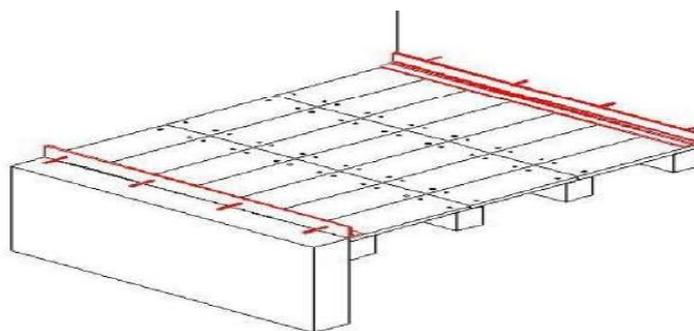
Reforço da ligação entre o pavimento e a parede (Brignola, 2008)
